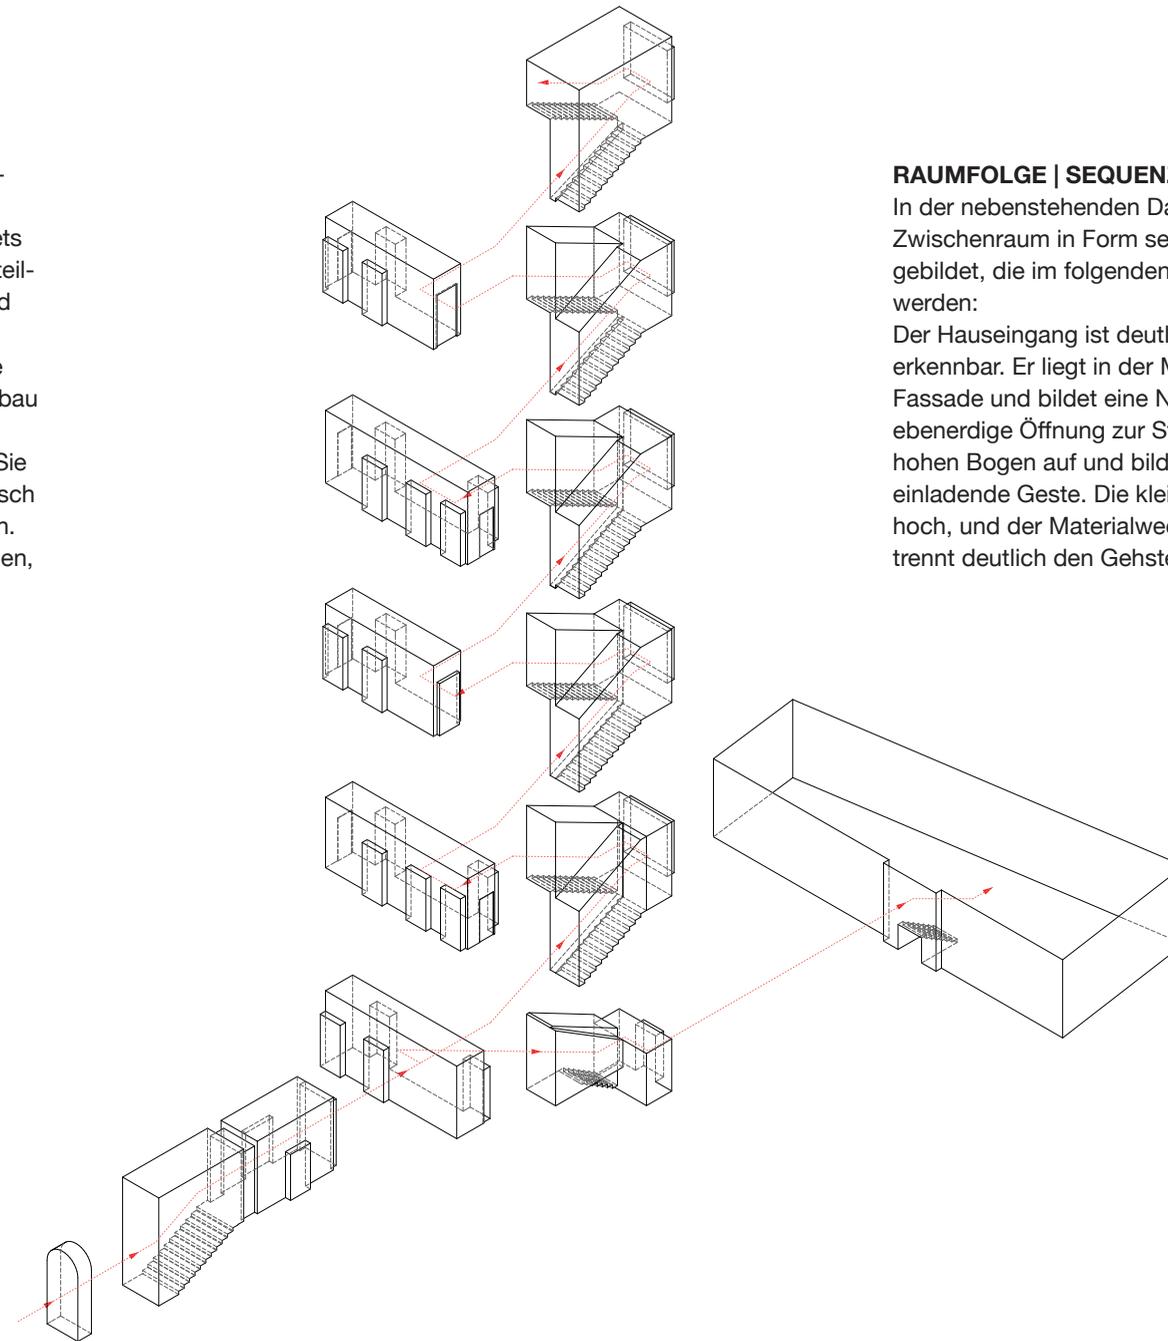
Der Zwischenraum als Explosionszeichnung – geteilt in seine einzelnen Sequenzen.
